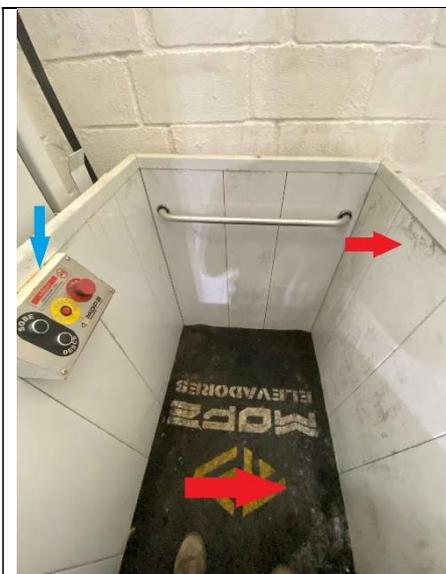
Autor – Foto da cabine, tirada no primeiro pavimento
